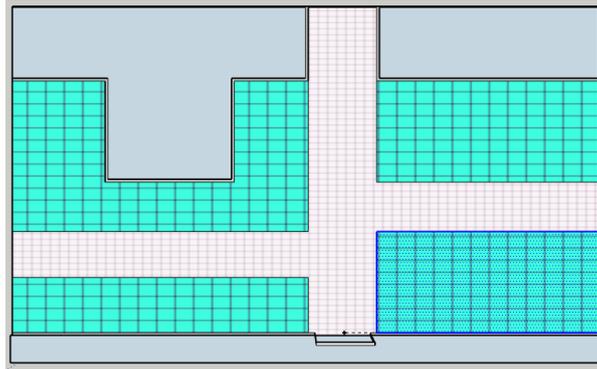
Rencana Lantai Ruang Kelistrikan dan Tata Boga
